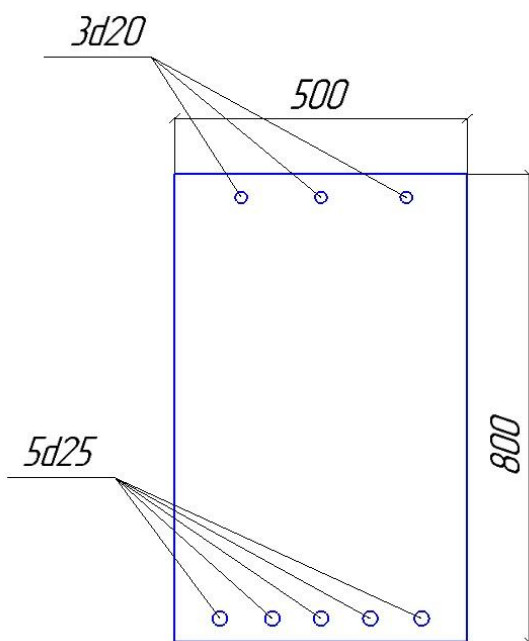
Рассчитываемое железобетонное сечение без усиления
